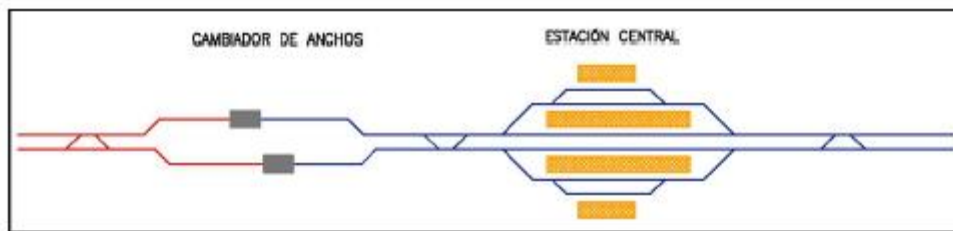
ESTACIÓ CENTRAL LAYOUT
